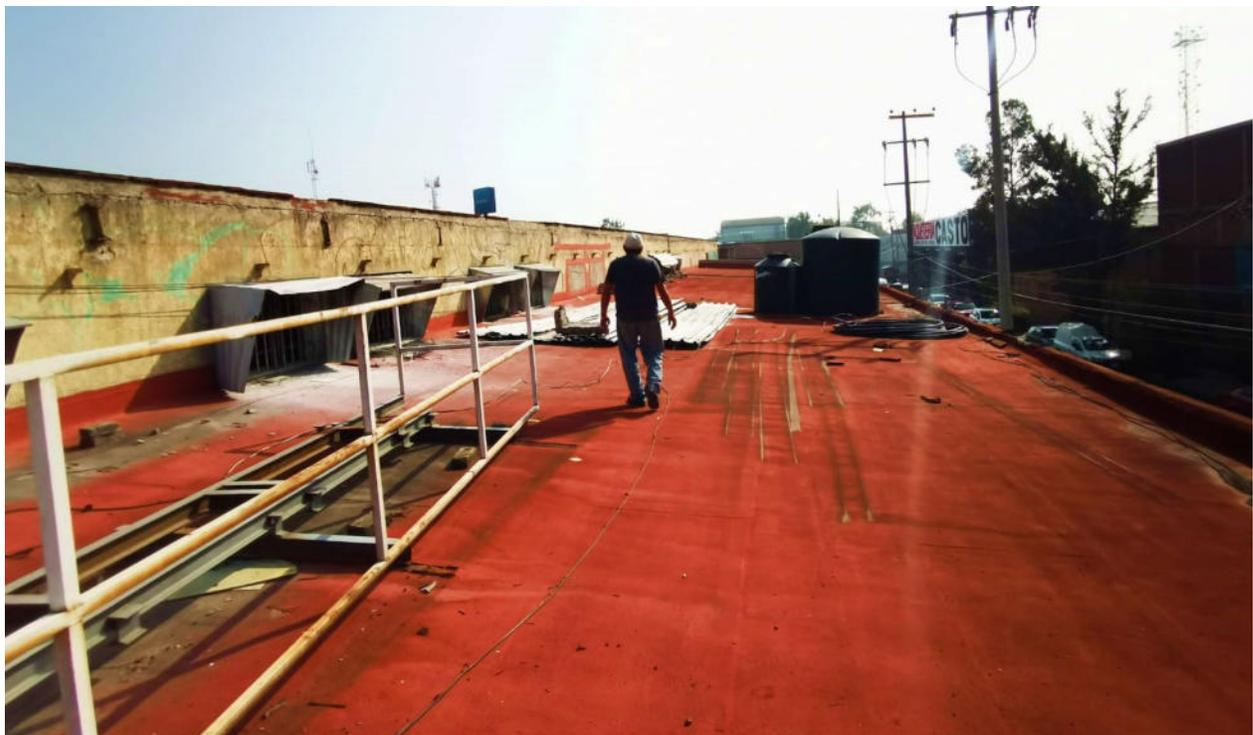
Vista de la azotea de la bodega donde será colocado el tanque de almacenamiento.
